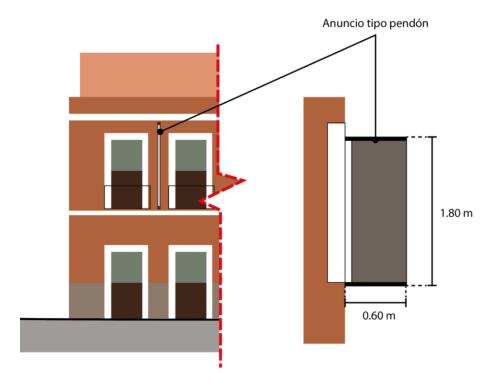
Esquemas en alzado y corte de un anuncio tipo pendón.
